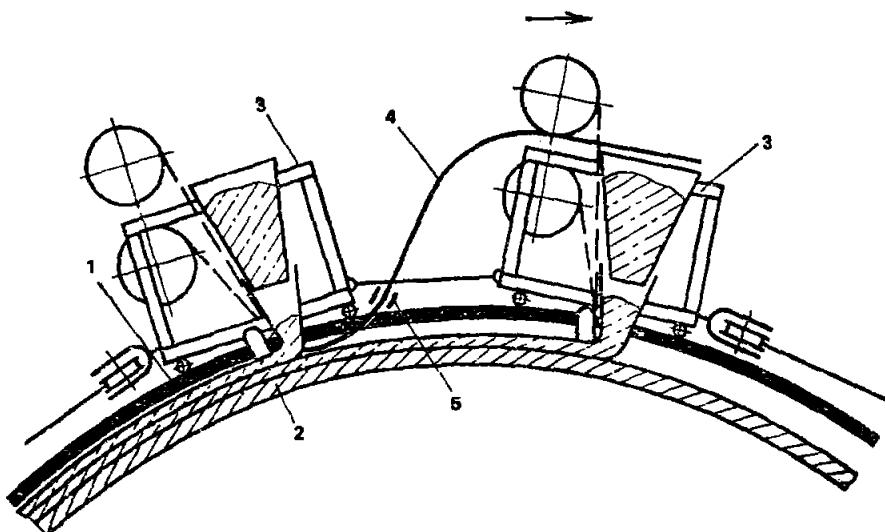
Конструктивная схема установки для послойного формирования элементов сводов
